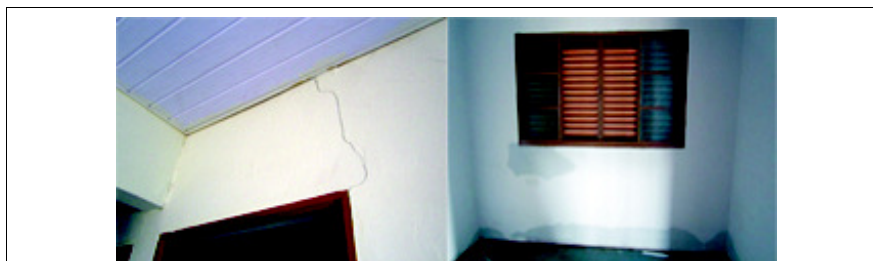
Patologias encontradas em unidades do Shopping Park. Fonte: Acervo Próprio
